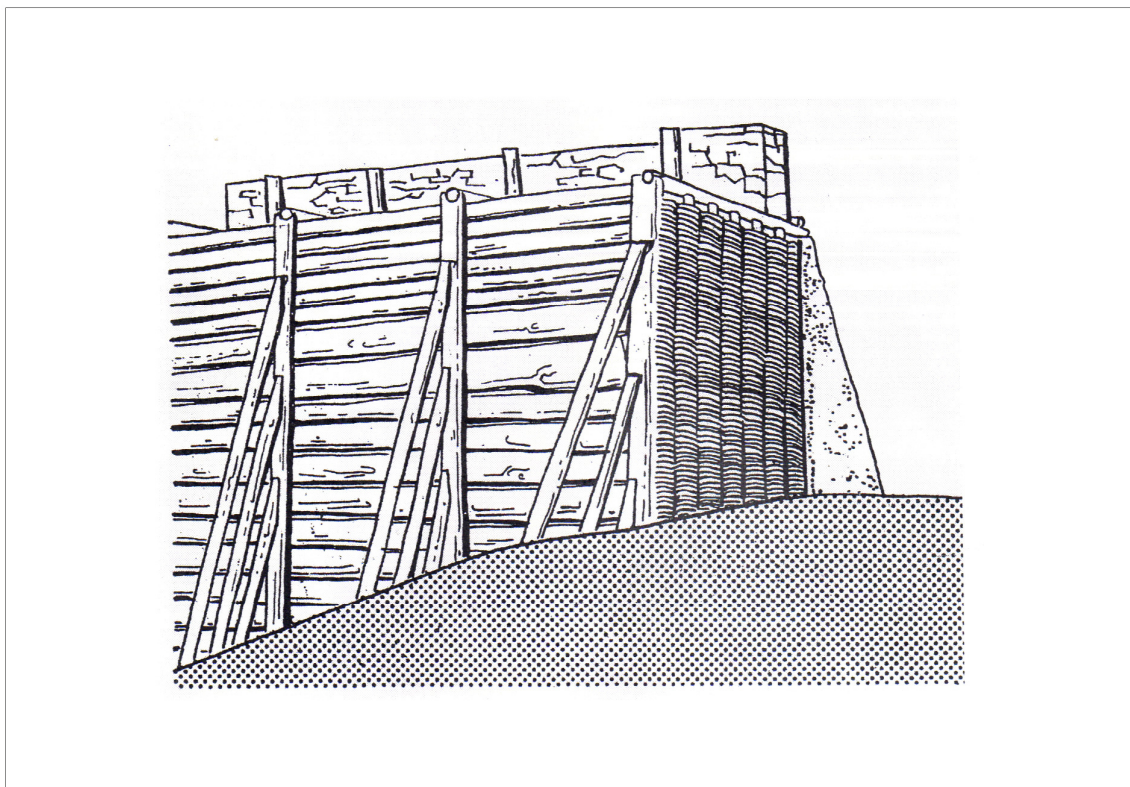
Eiringsburg (Ldkr. Bad Kissingen). Rekonstrukce hradby; volně stojící nasucho kladená zeď stavěná skořepinovou technikou (Ettel 2006, 35, Obr. 2.).
